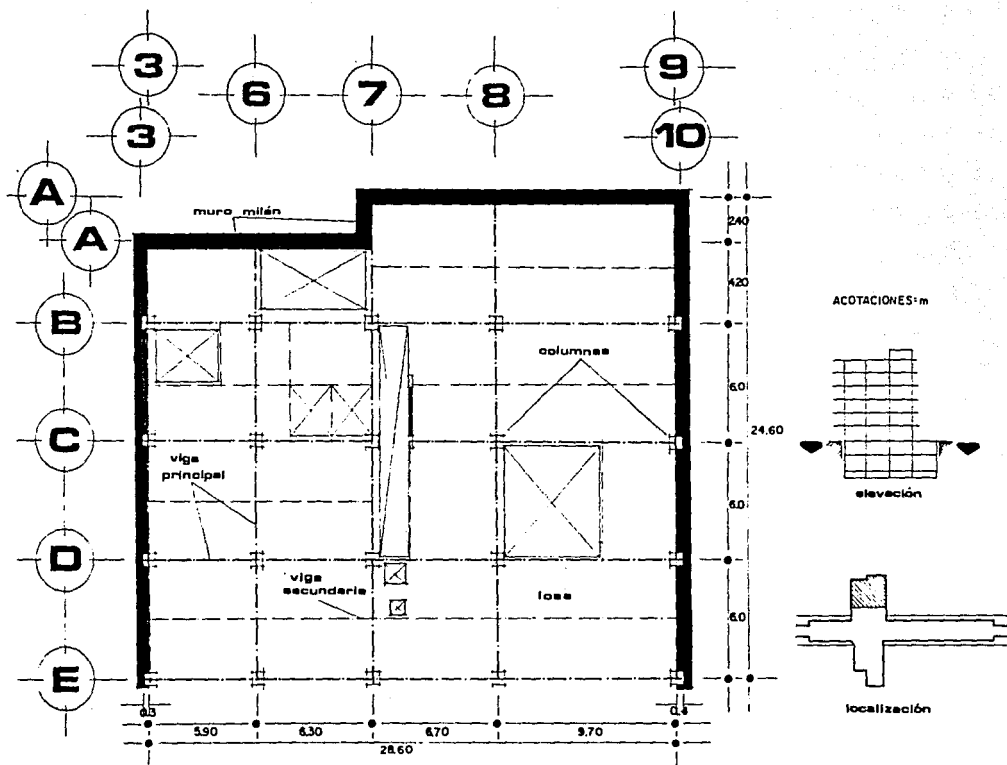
PLANTA DEL NIVEL ACCESO
